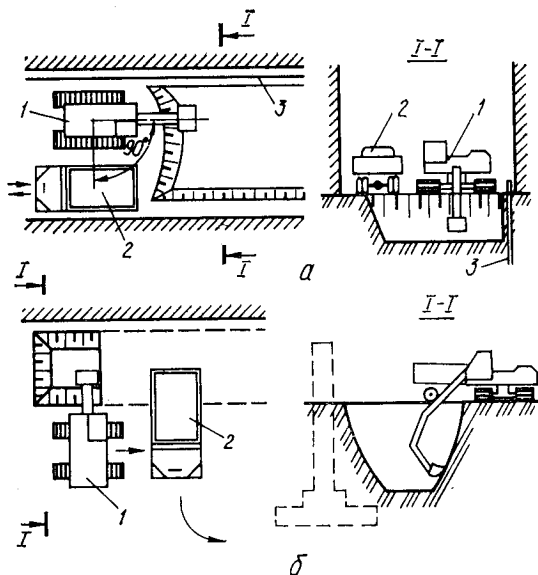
Разработка грунта экскаватором с обратной лопатой вблизи конструкций:
